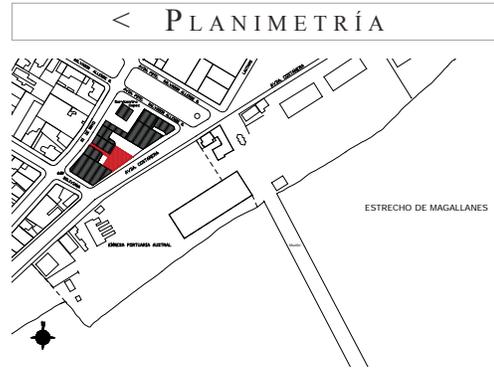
PLANTA UBICACIÓN MERCADO ACTUAL (MANTIENE LAS MISMAS CALLES CIRCUNDANTES DEL MERCADO ORIGINAL).
